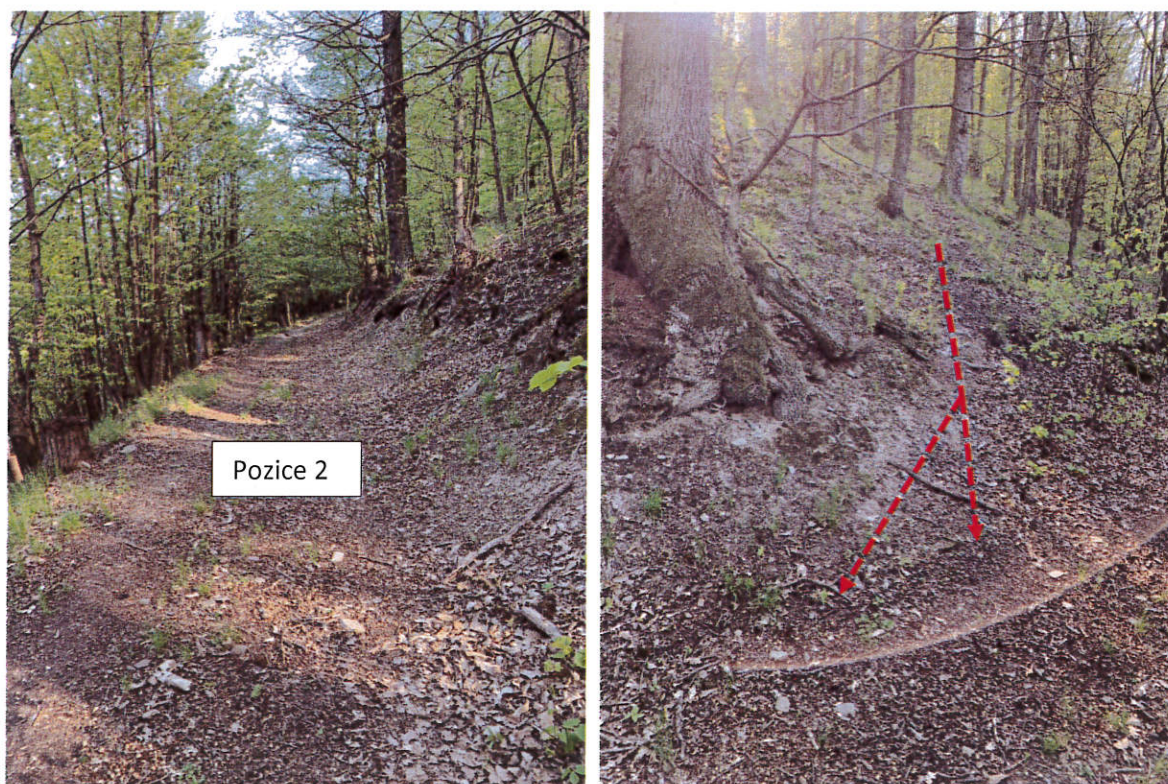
pohled na lesní cestu s kótou cca 295 m n.m., foto 6 – pohled z pozice 2 směrem k pozici 3
